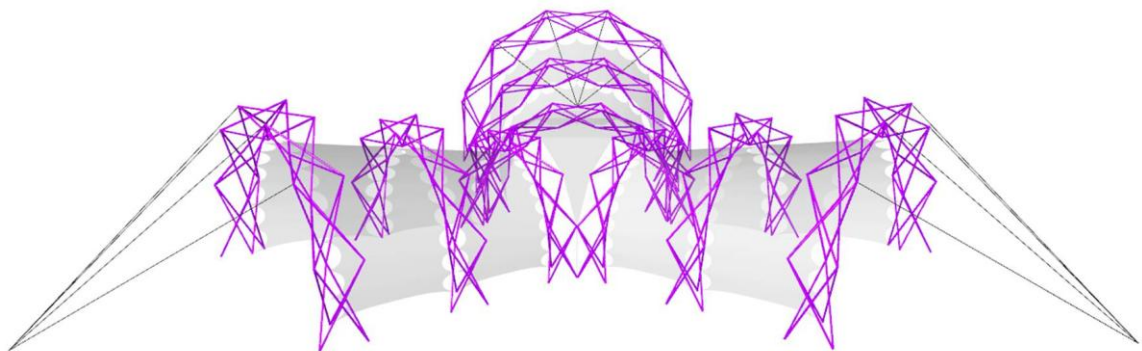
Pabellón Vertex. Geometría vista perspectiva.
